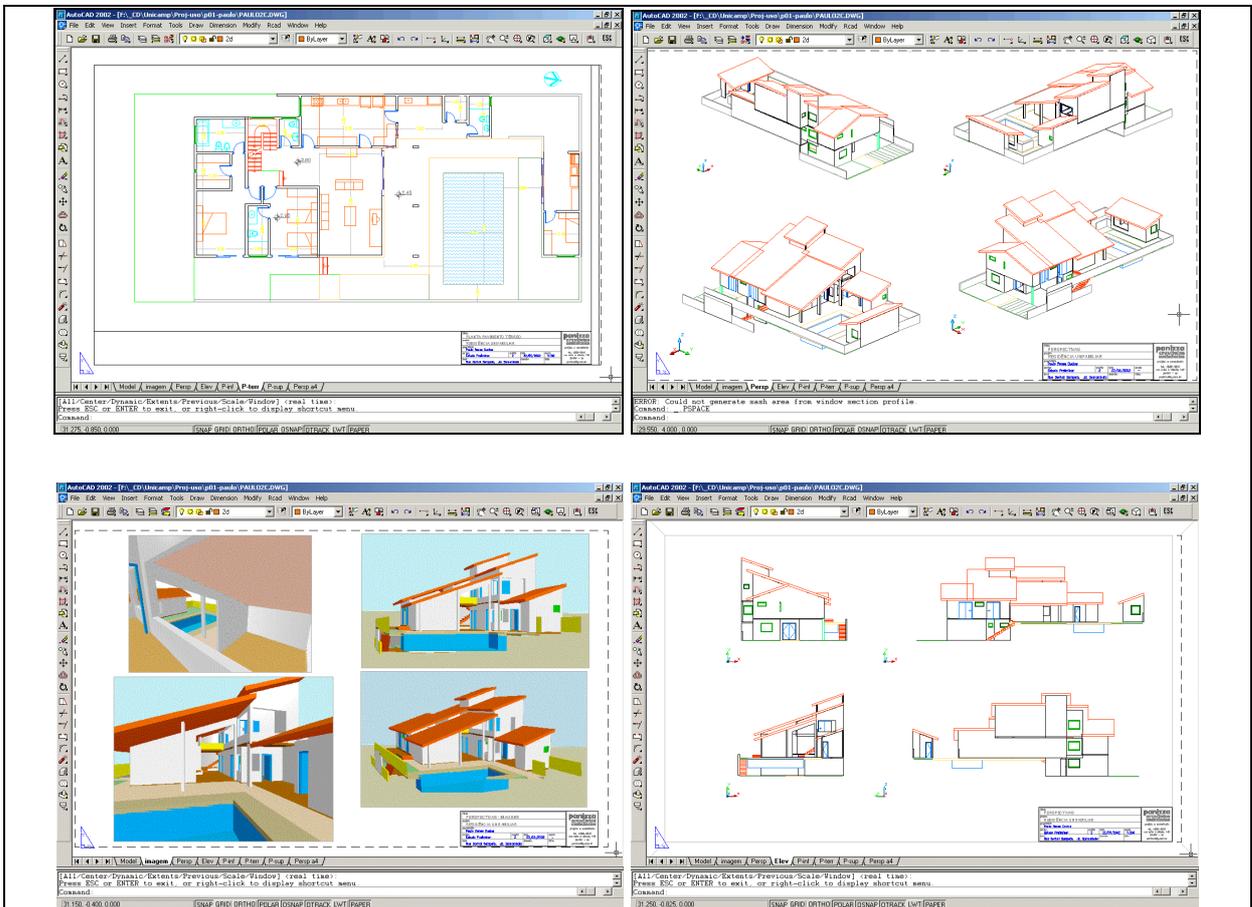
Folhas de impressão da uma planta, de perspectivas e de elevações do arquivo do estudo preliminar - Projeto 2 – Panizza
